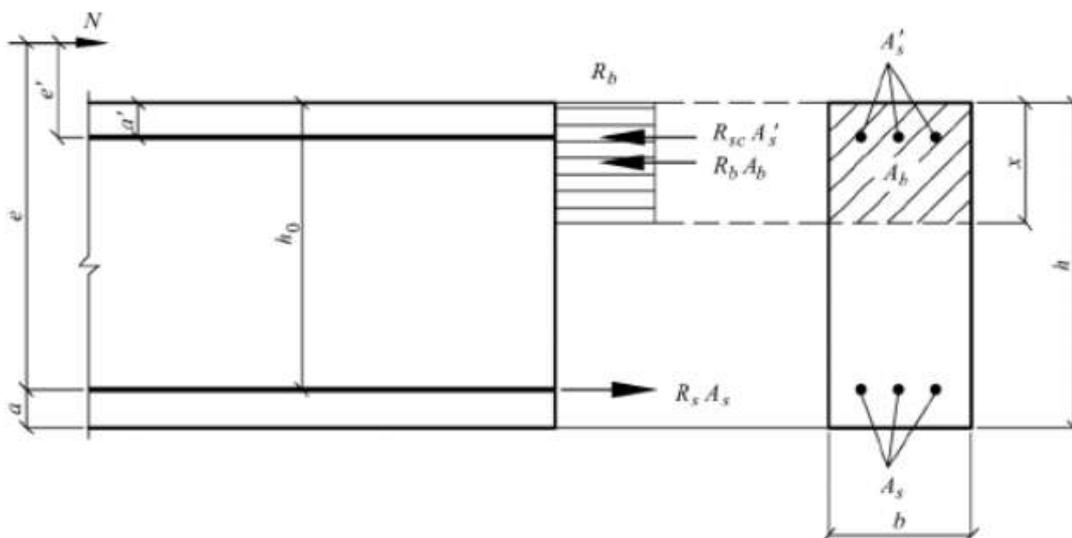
Схема усилий и эпюра напряжений в сечении, нормальном к продольной оси изгибаемого железобетонного элемента, при его расчете по прочности
